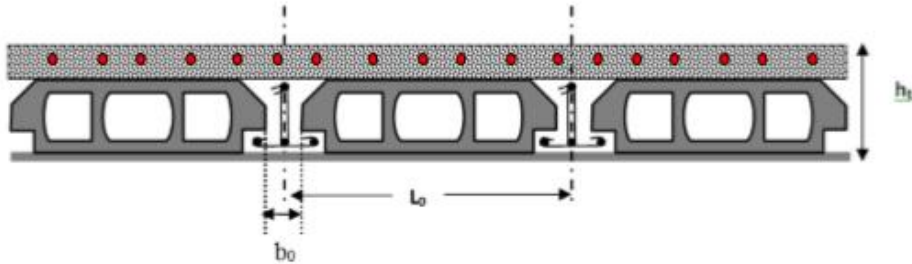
Coupe transversale d'un plancher à corps creux
